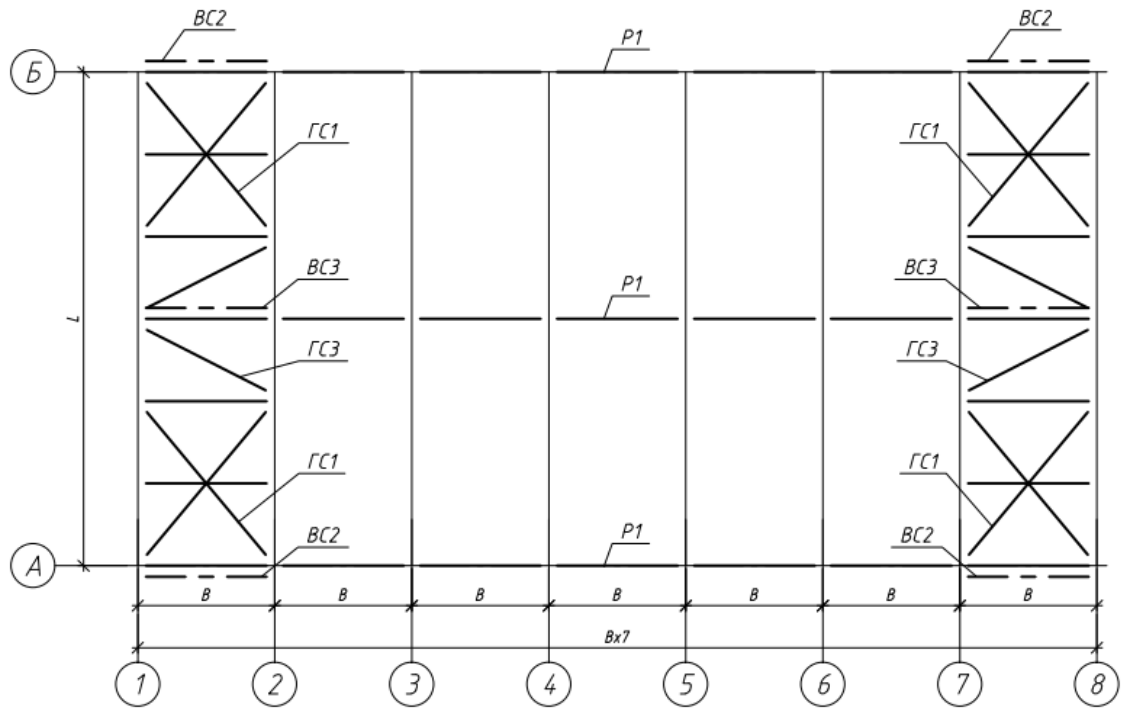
Горизонтальные связи по верхним поясам ферм
